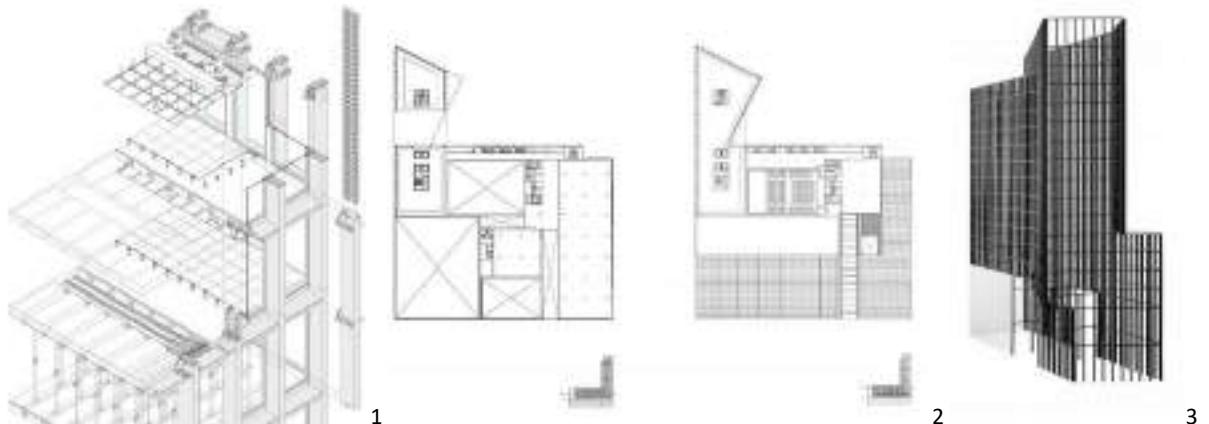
1. Detalle constructivo estructura-fachada. 2. Plantas del edificio. 3. Maqueta virtual en la que se verifica la configuración formal tectónica.
